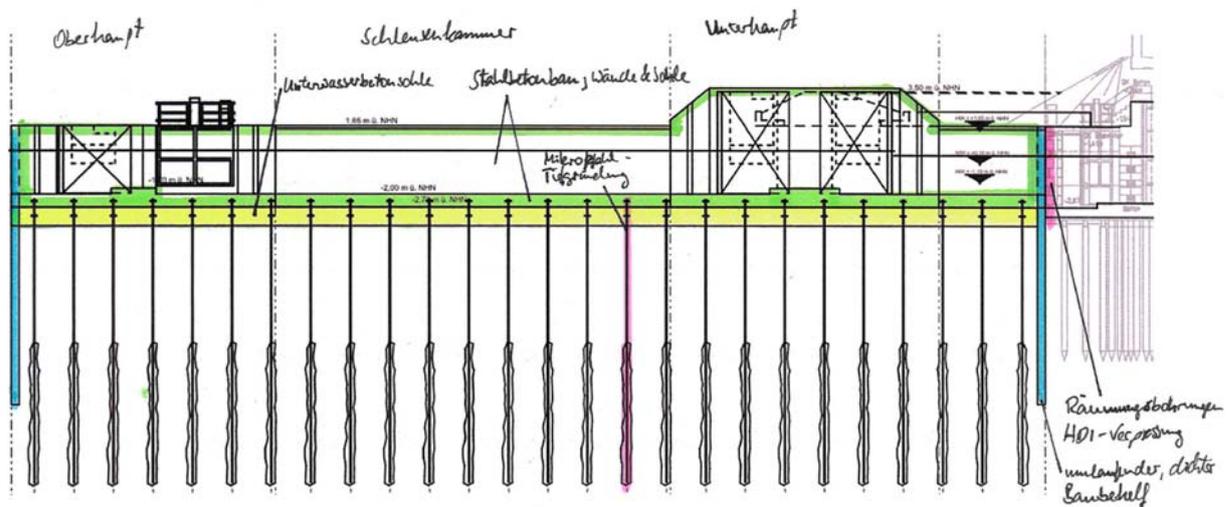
Variante 1 (Bestandssanierung mit Stahlbetontrog) - Bauzustand, Längsschnitt
